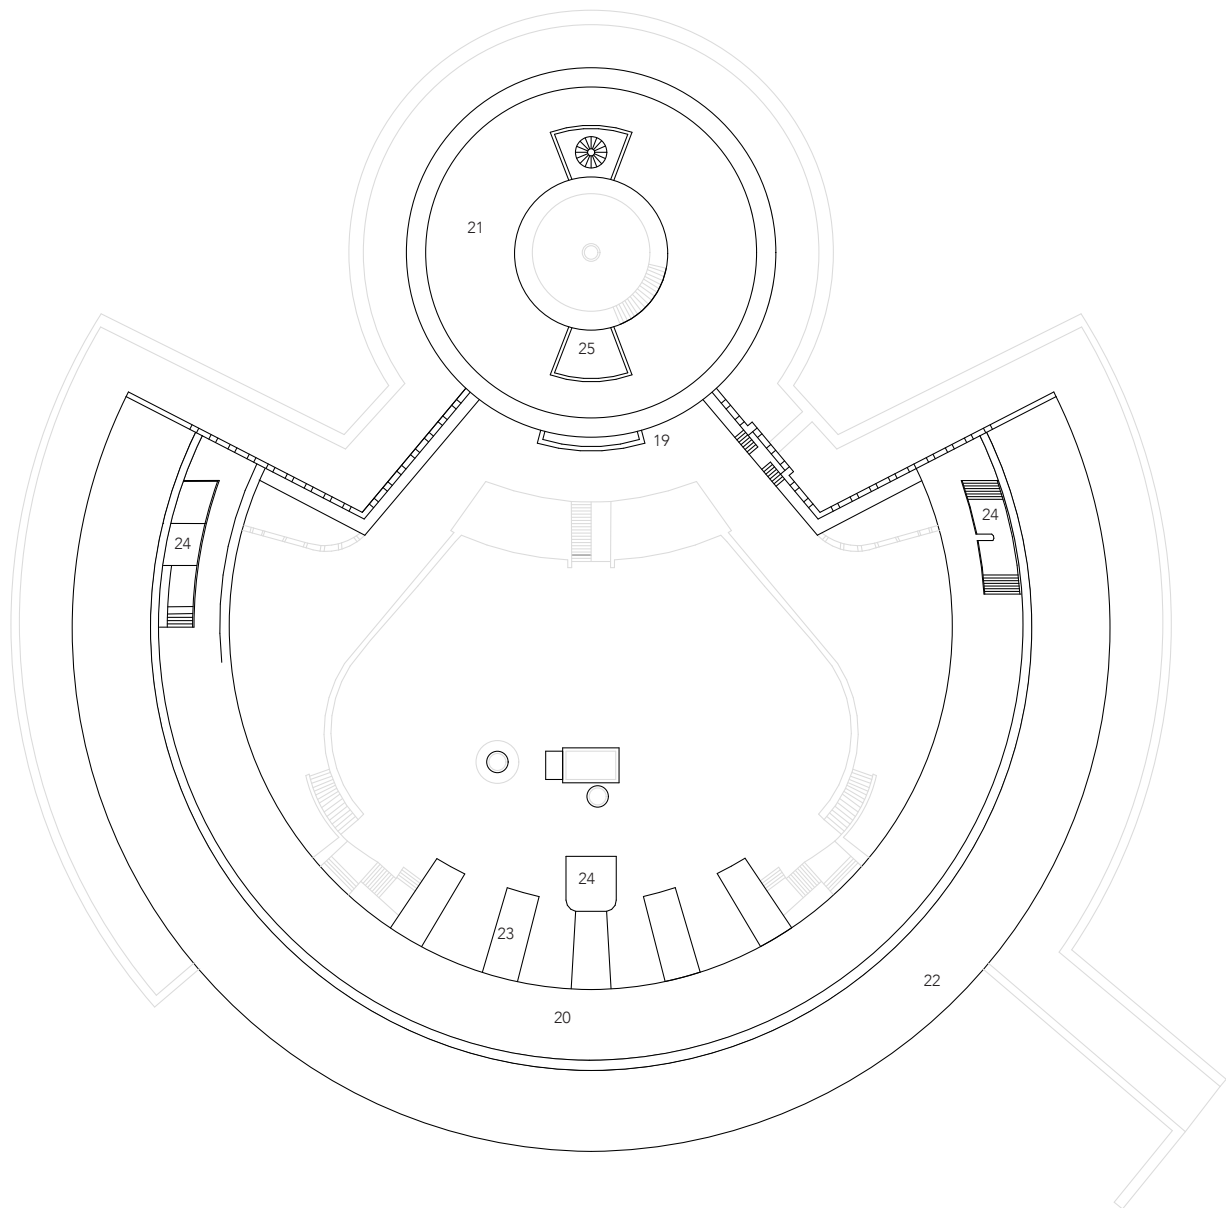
Grundriss Erdgeschoss Seefort Mamula 1:750
